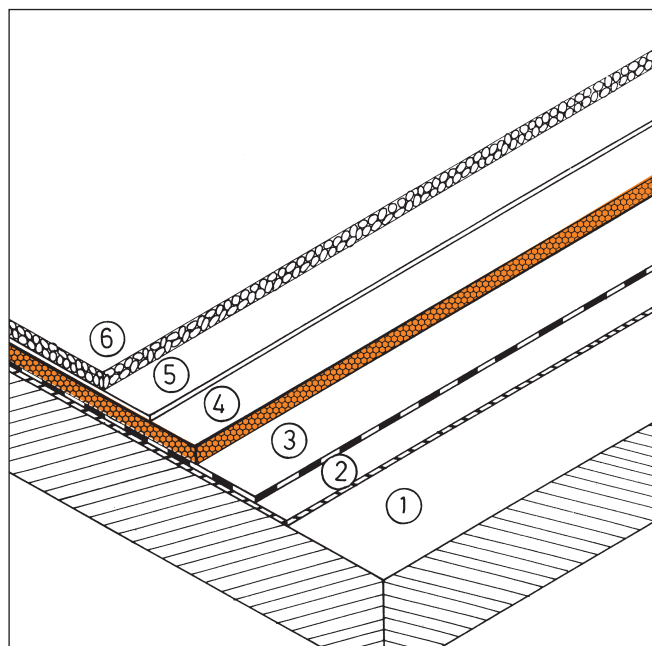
Isolamento di tetto piano sopra impermeabilizzazione (tetto rovescio).
